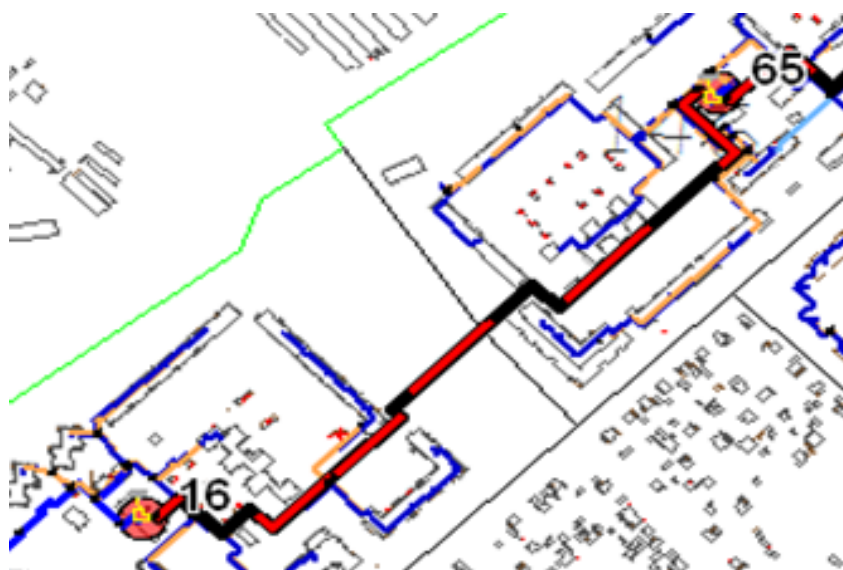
Схема прокладки трубопровода между котельными №65 и №16
